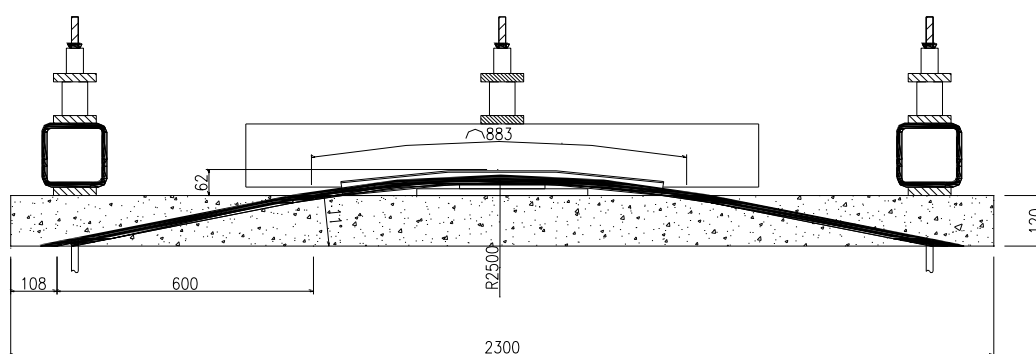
Traçado transversal dos cordões de pré-esforço nos modelos DF5 a DF6 e traçado dos cordões 1 e 2 do modelo DF7, corte pelo cordão (desenho sem escala e dimensões em mm).
